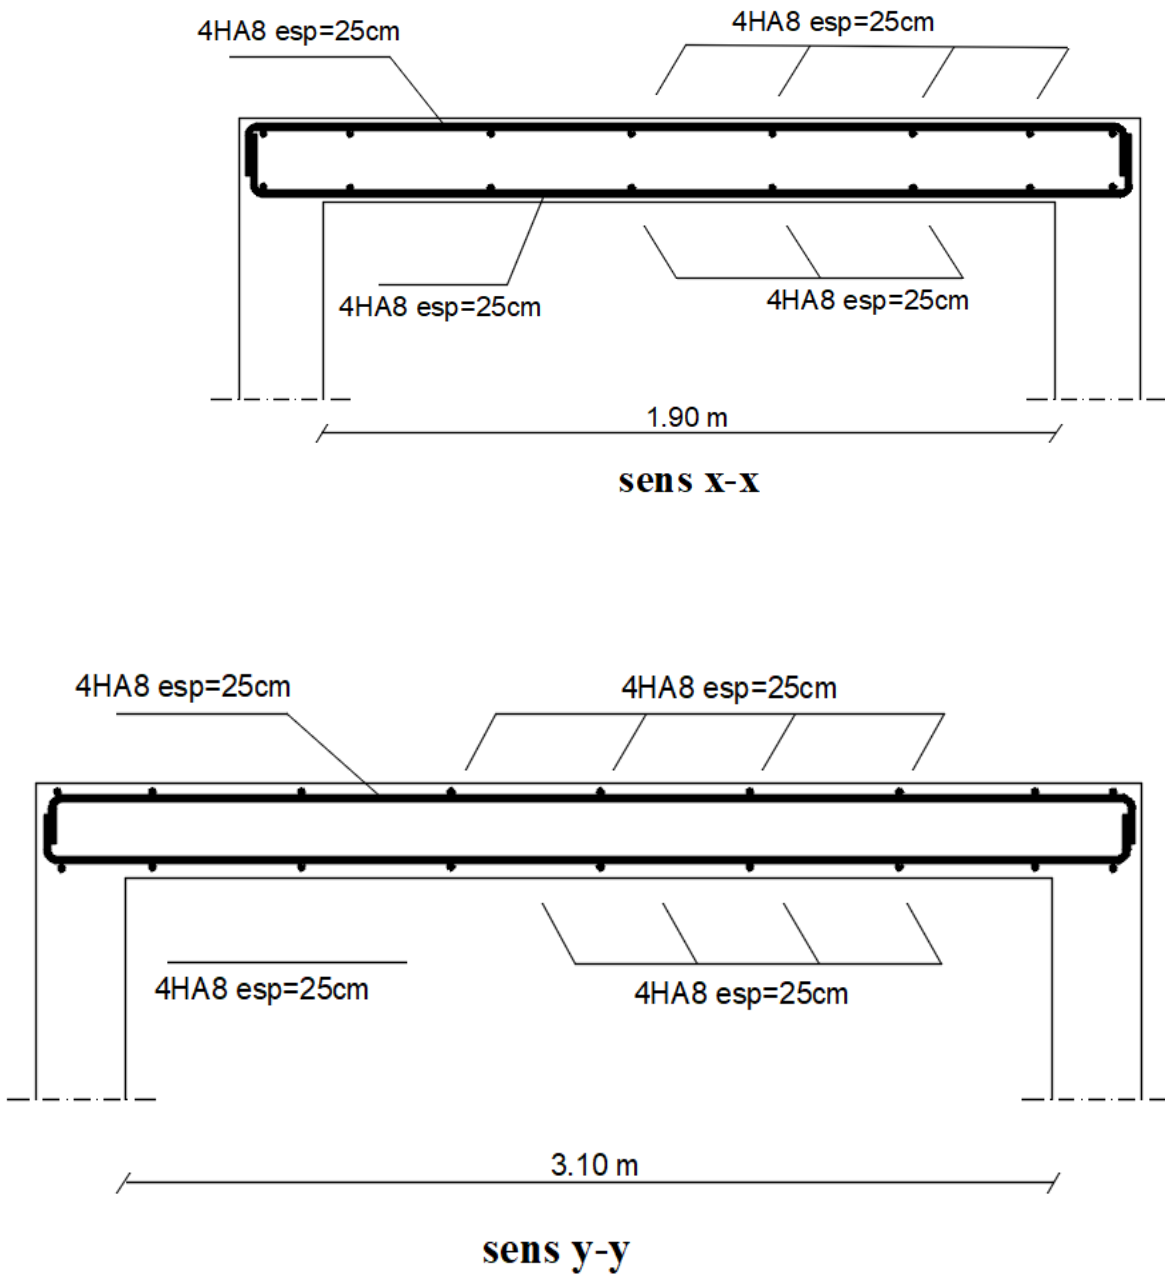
Ferrailage de la dalle pleine hall ascenseur sens (X-X) et (Y-Y)
